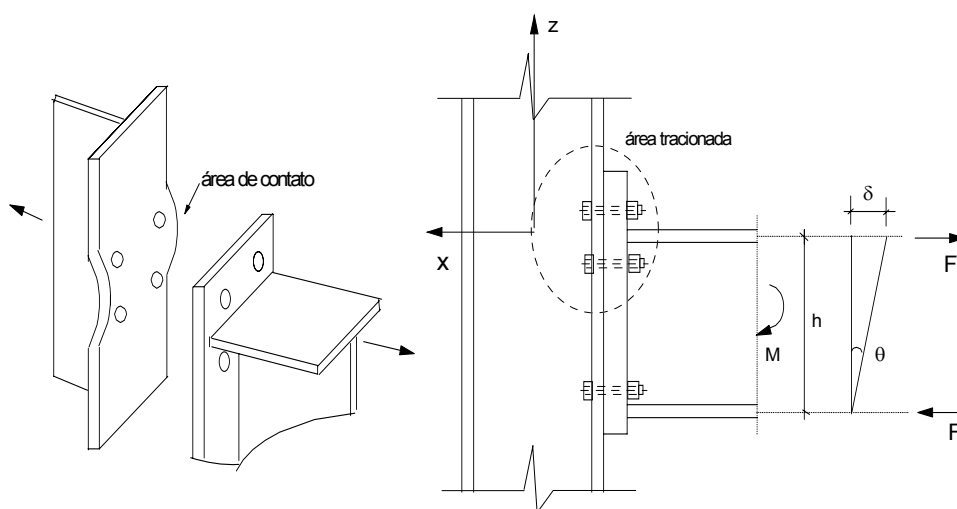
Detalhe da zona de contato e o carregamento no plano⁸⁹.
